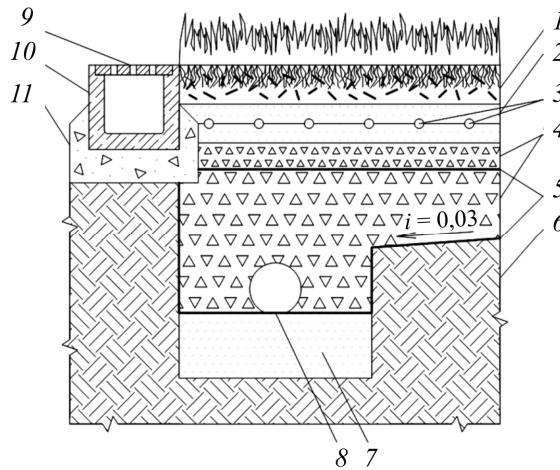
Разрез футбольного поля: 1 – газон на фиброармированном основании; 2 – песчаный слой; 3 – трубы системы подогрева; 4 – дренажный слой (щебень разных фракций); 5 – геотекстиль; 6 – уплотненный грунт; 7 – песчаный слой; 8 – дренажная труба; 9 – металлическая решетка для стока воды; 10 – бетонный лоток; 11 – бетон В25
